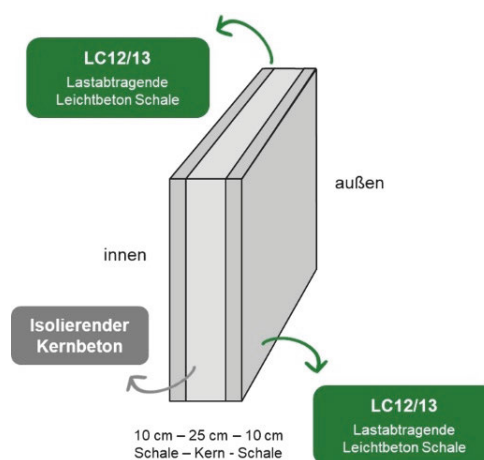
Wandaufbau multifunktionaler Leichtbetonausführung [6]
